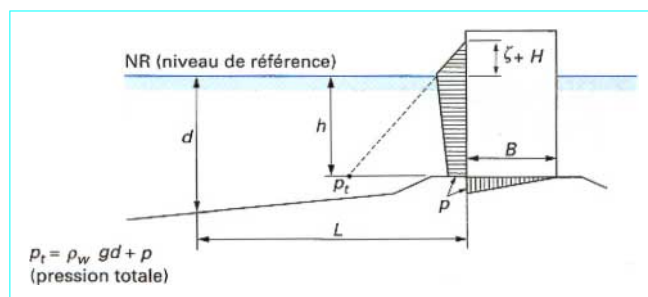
Surpressions dues à la houle non déferlante sur une digue verticale
